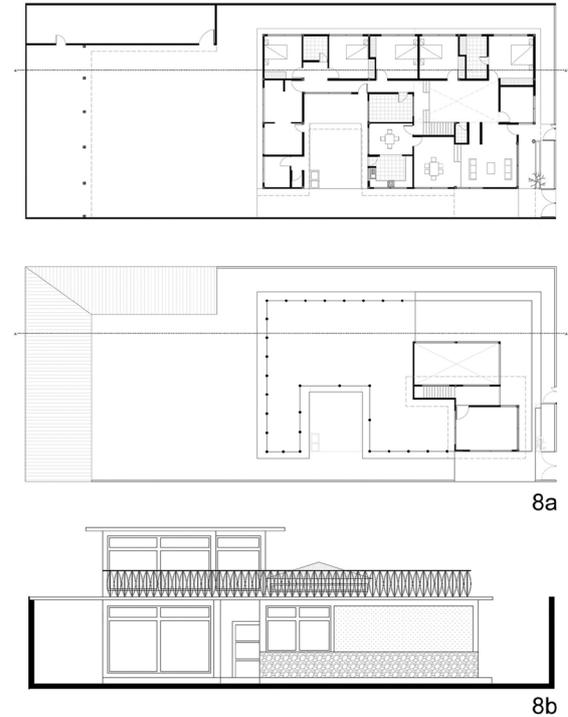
, Plantas arquitectónicas, elevación y sección constructiva casa Rodríguez.
